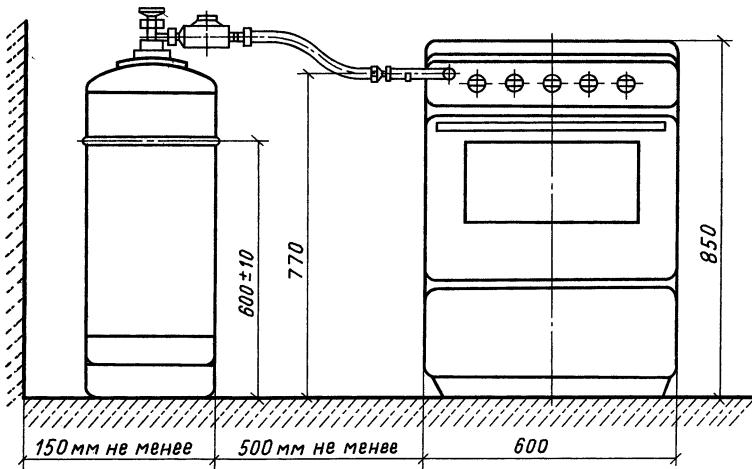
Установка плиты газовой бытовой с баллоном
